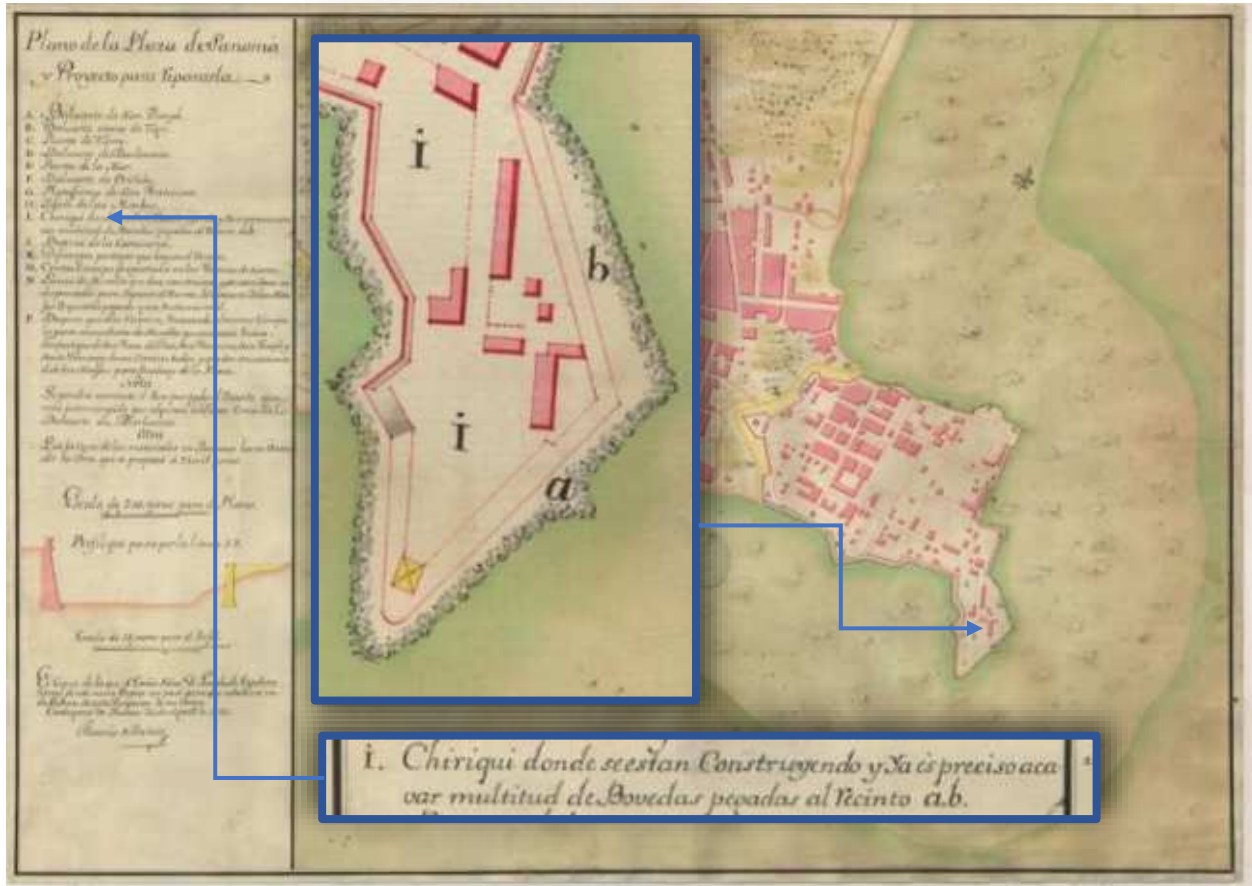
Plano de la Plaza de Panamá y Proyecto para repararla. Fuente, (De Arebalo, 1791), Imagen adaptada por autor.
